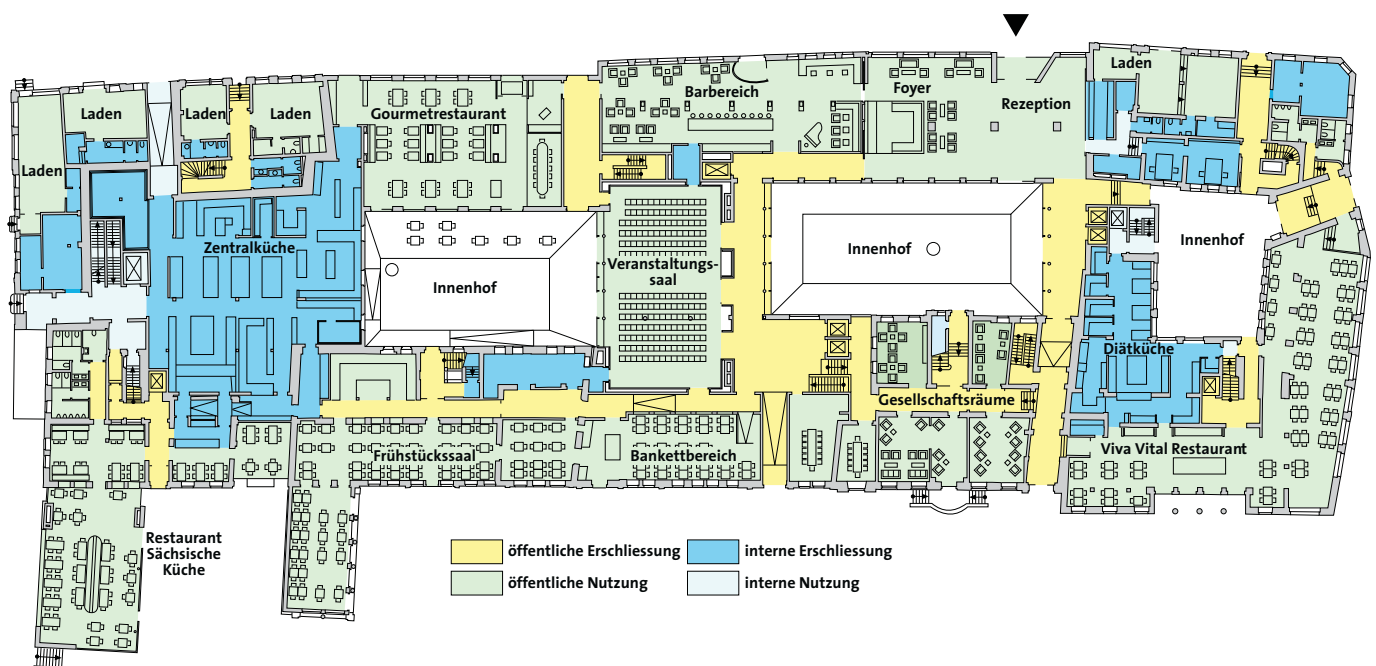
Erdgeschoss-Grundriss mit Übersicht der Funktionsbereiche
